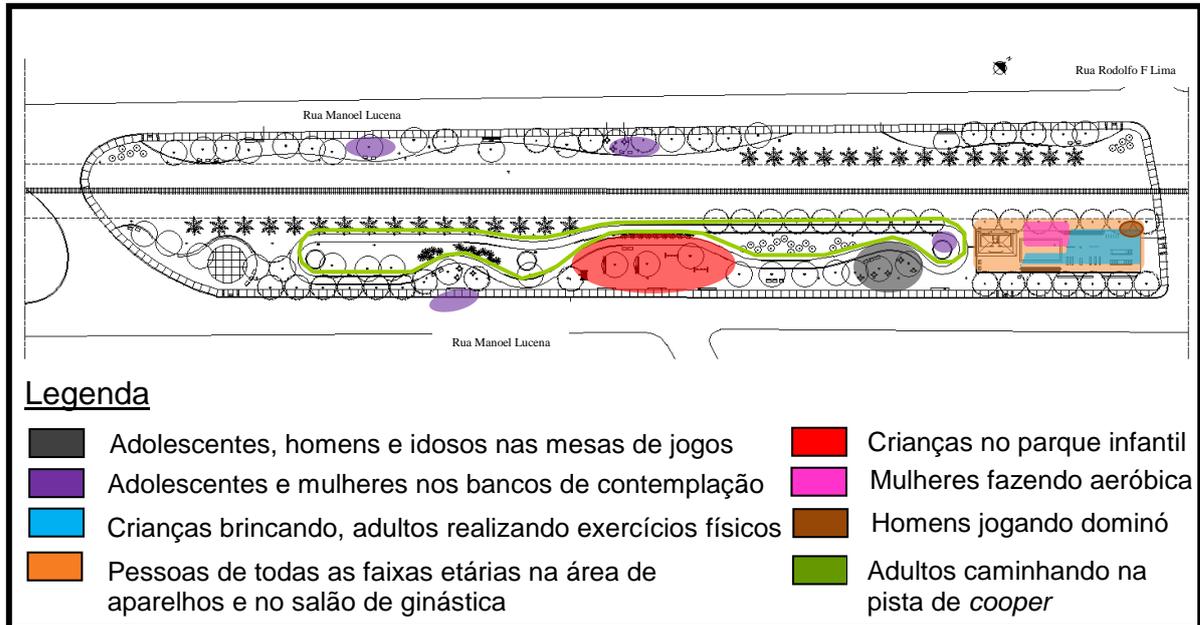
Planta Baixa da Academia da Cidade de Timbaúba
